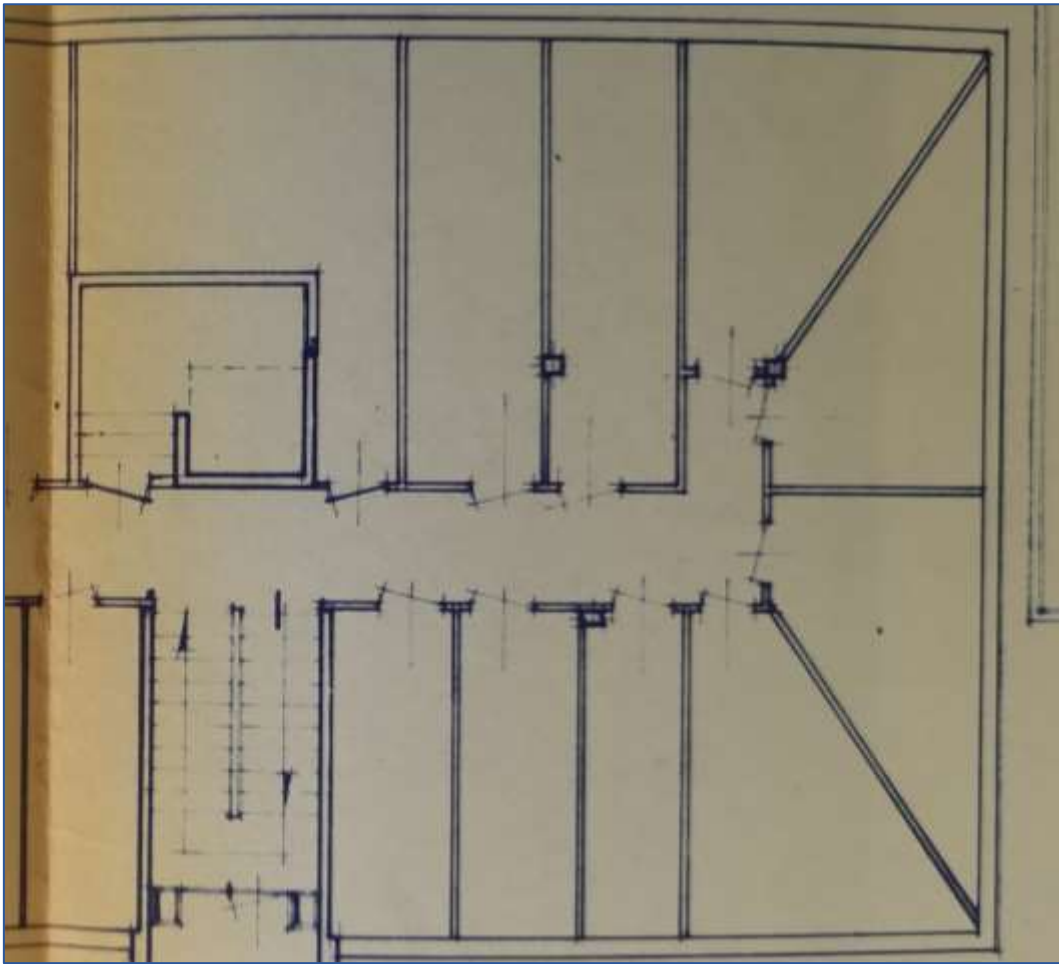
Estratto tavola di progetto atti di fabbrica - solaio
